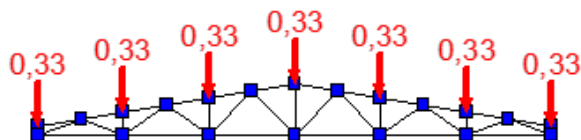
Схема прикладання снігового навантаження до ферми
